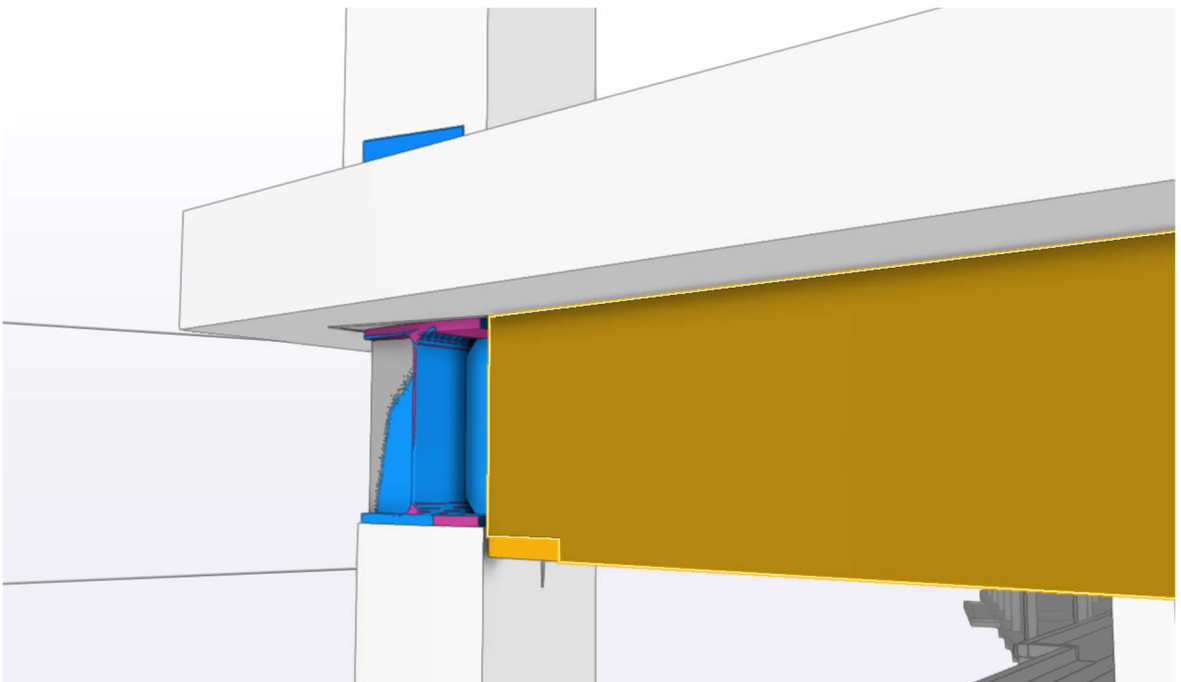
Ligação viga-viga (Fonte: Software Tekla, 2023)
